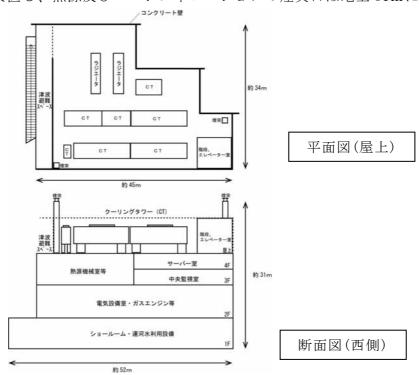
(1) エネルギー施設Aの平面図及び断面図
